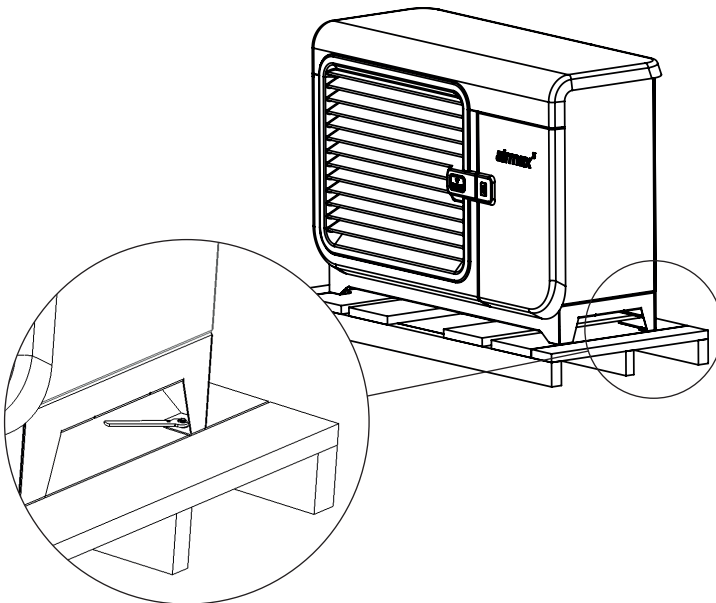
Entfernen der Transportsicherung - Lösen der Befestigungsschrauben an der Transportpalette mit einem Schraubenschlüssel
